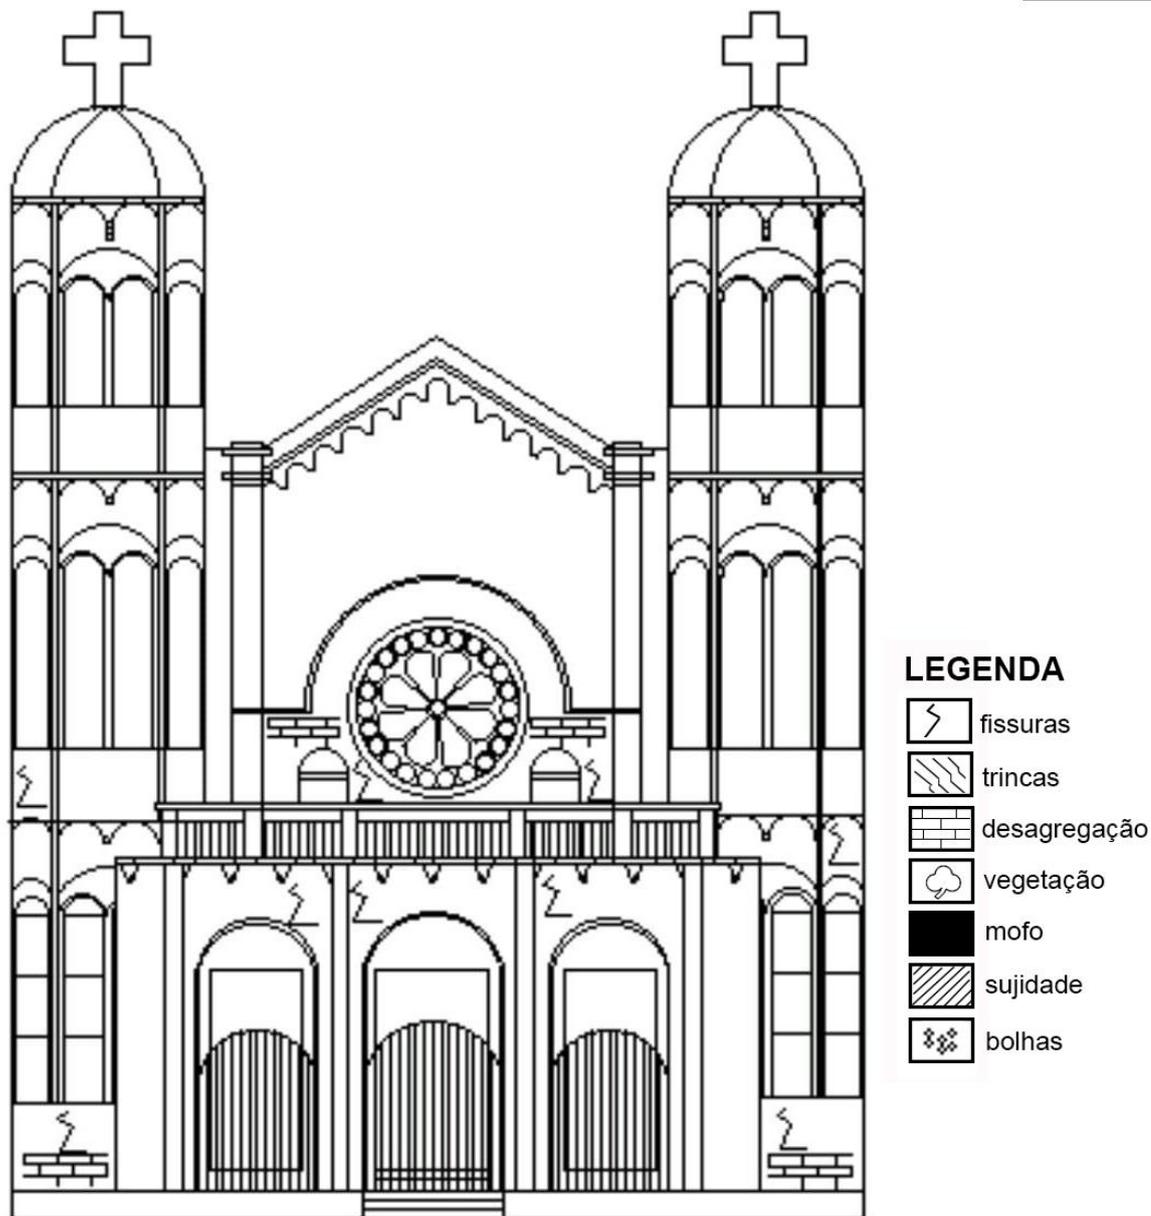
Fachada Nordeste da edificação: sujidades e fissuras.
